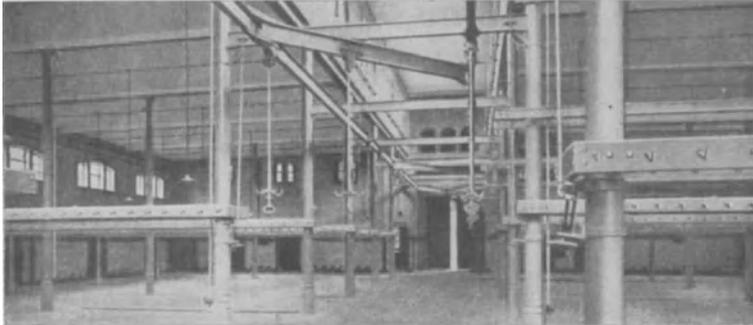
Kleinviehschlachthalle mit Hakengerüsten und Einschienenbahn.
